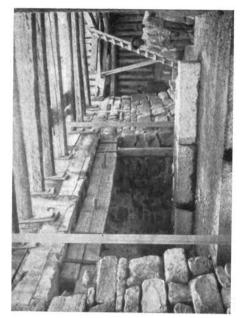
Innesto della nuova muratura di fondazione nell'antico massiccio conservato
